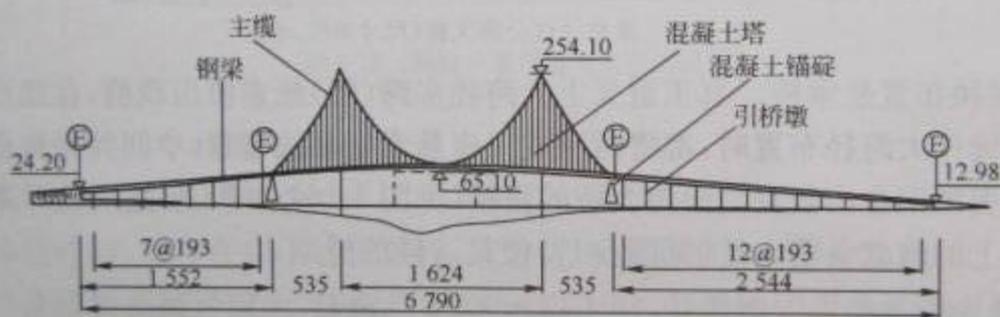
丹麦大贝尔特东桥(尺寸单位:m)
